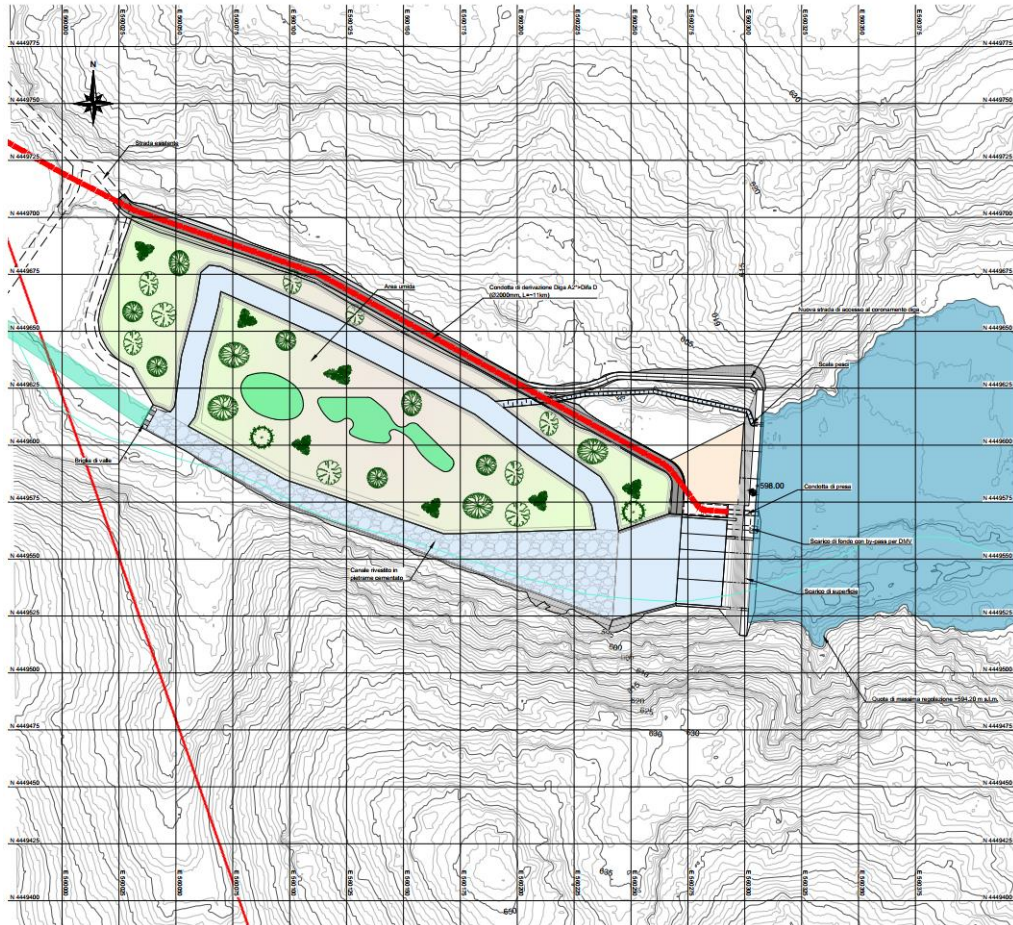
Alternativa 2 (A2*+D), diga A2*, planimetria (estratto da [30])
